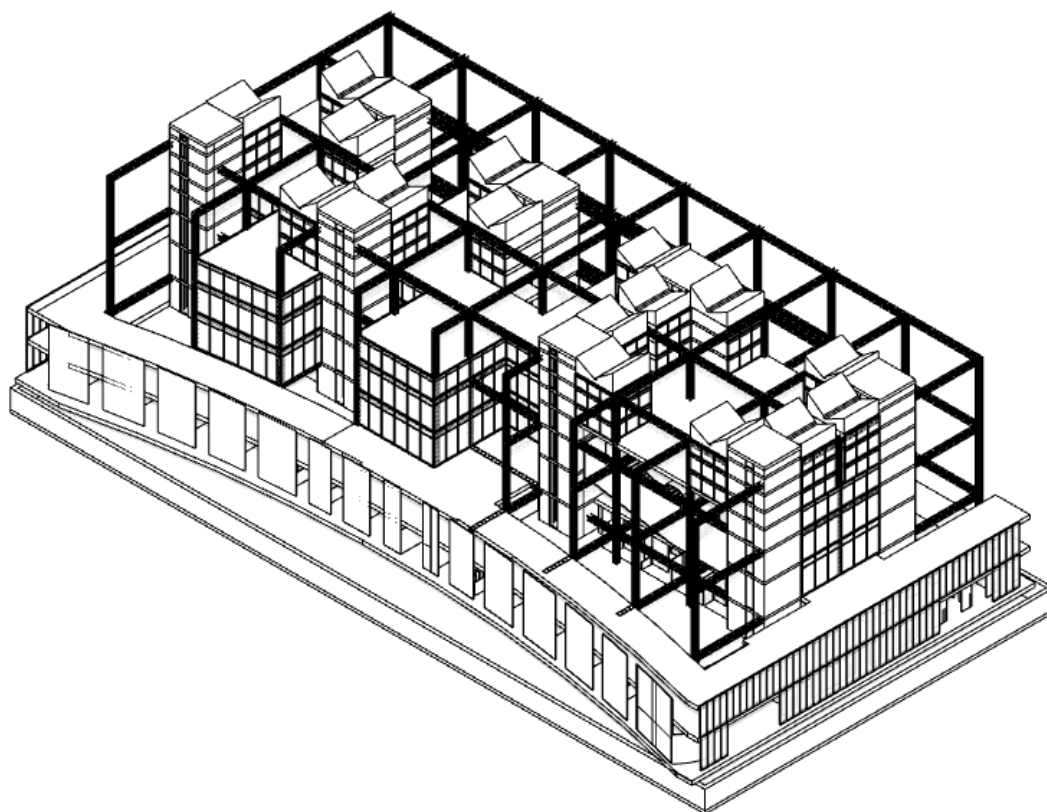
Axonometría general proyecto Arquitectónico en el lote
